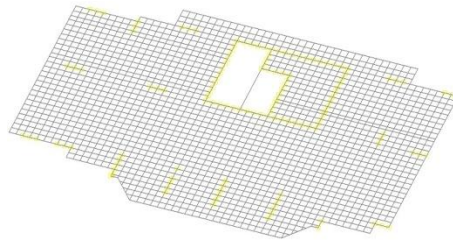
Розрахункова схема багатопорожнистої плити перекриття
